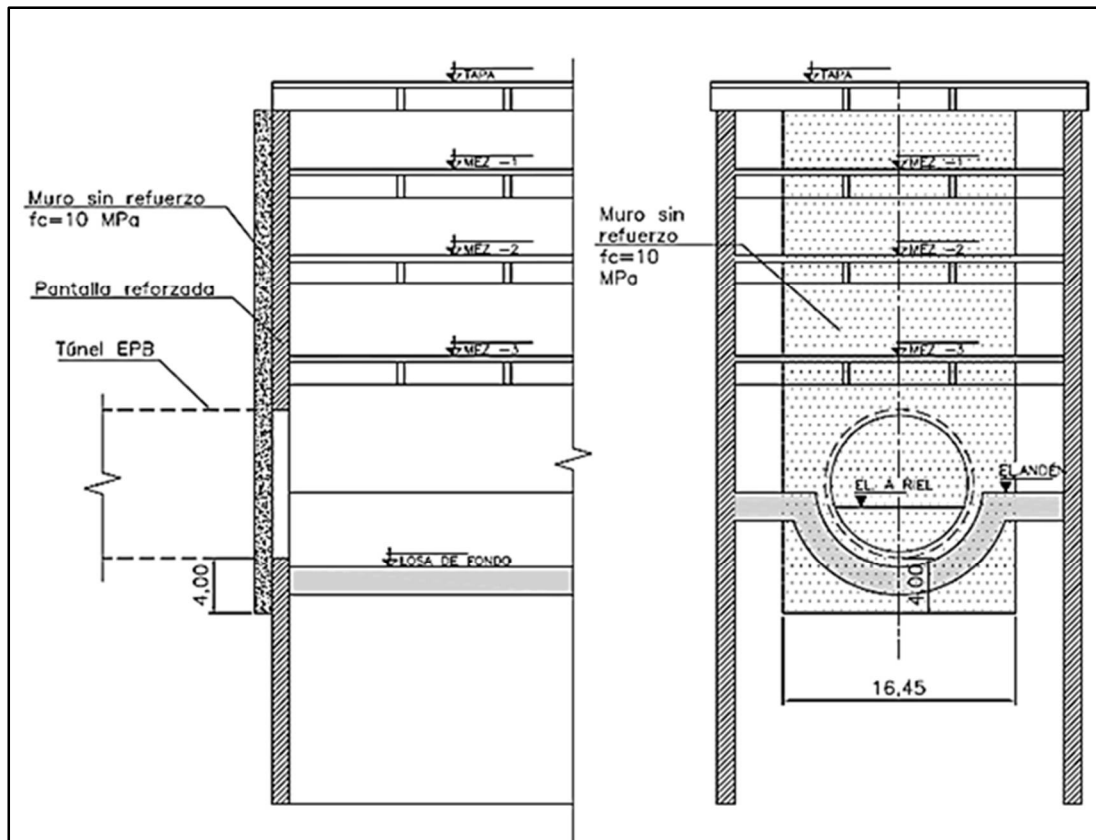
Muro a las entradas y salida de las estaciones (perfil y sección)
